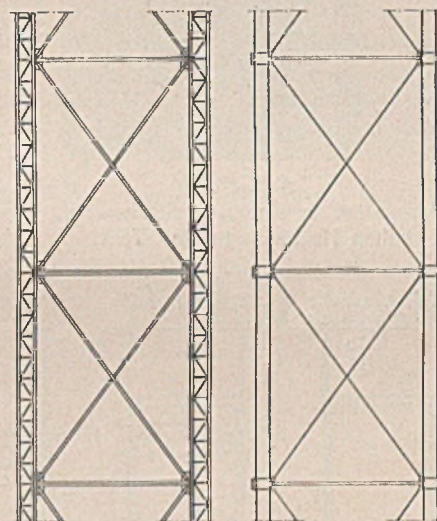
Vergleich eines vergitterten Stahlgerüsts mit einem Rohrgerüst.
